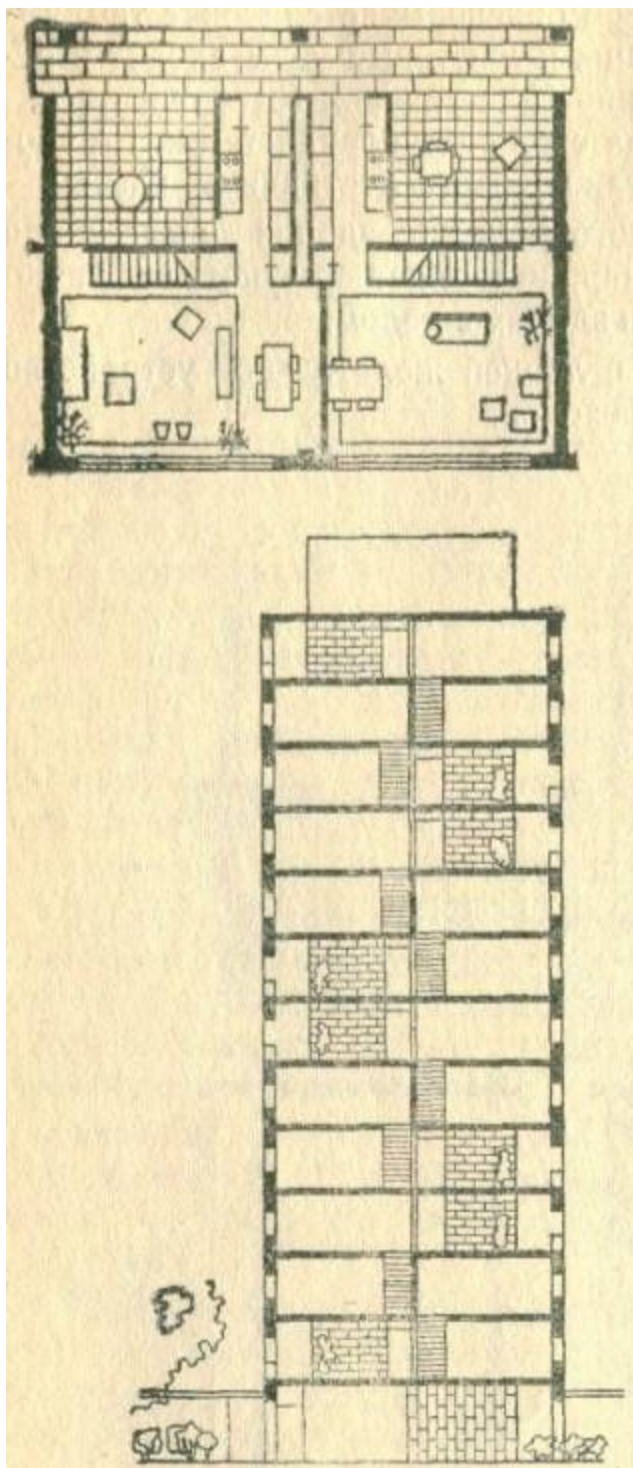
Фасад и план односекционного жилого дома квартирами в двух уровнях
